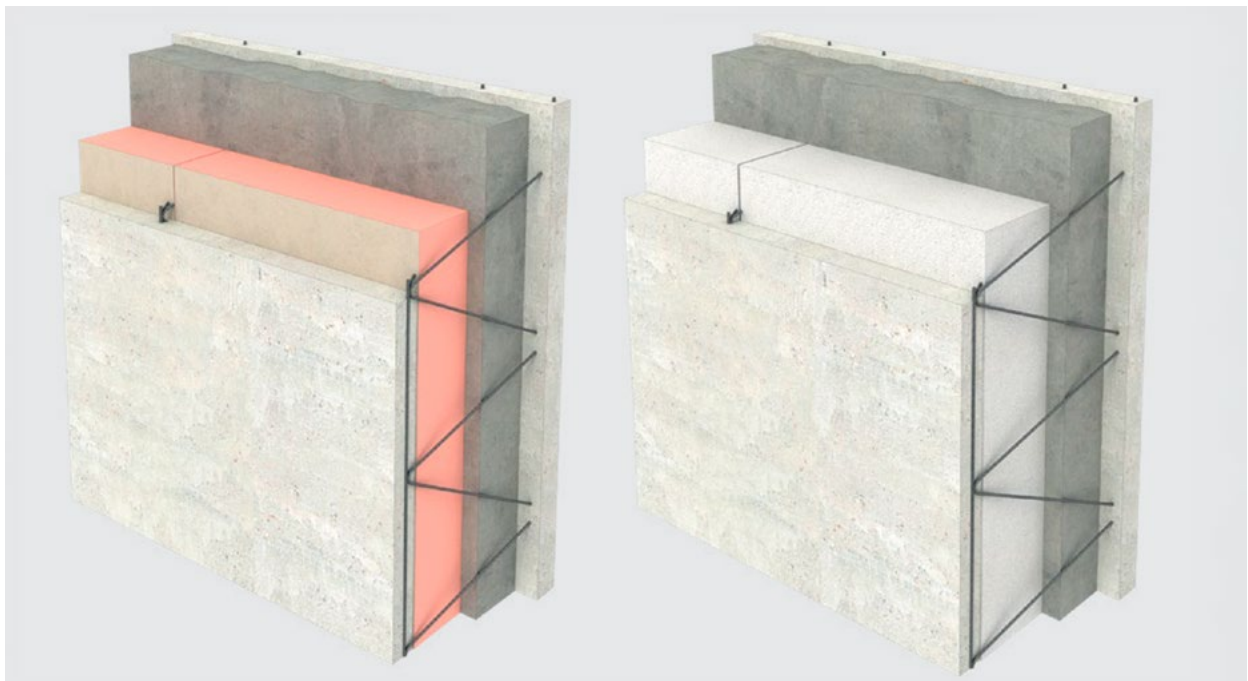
Betonsandwichwandkonstruktionen mit Kooltherm K20 (links) und EPS (rechts).
